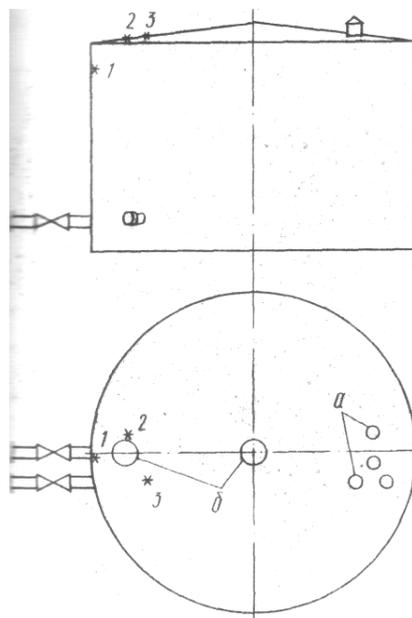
Схема размещения мест отбора проб отложений в нефтяных резервуарах:
